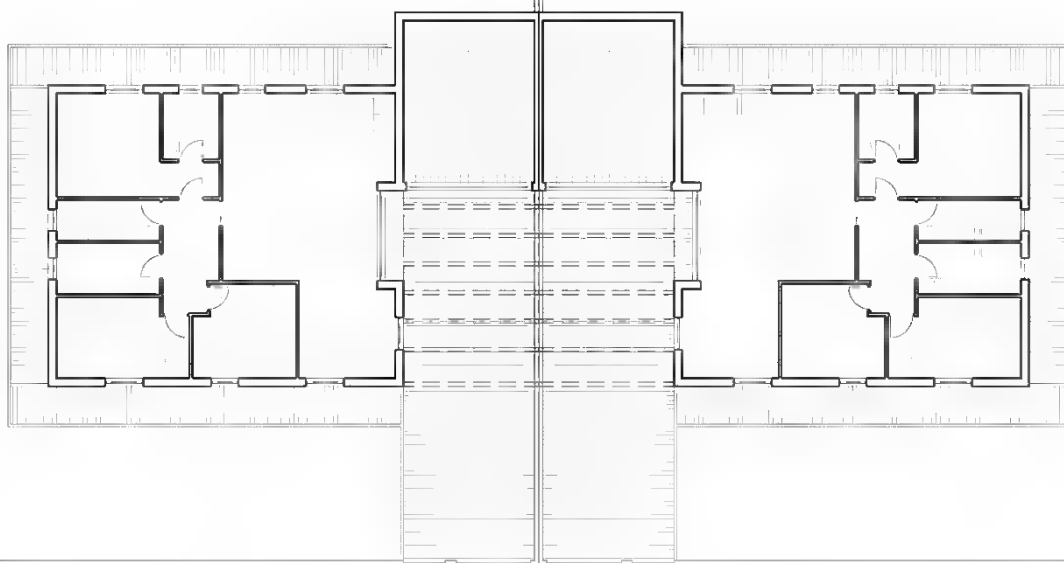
La tipologia edilizia n.2 utilizzata nella progettazione del Piano di Lottizzazione di Parco Le More
